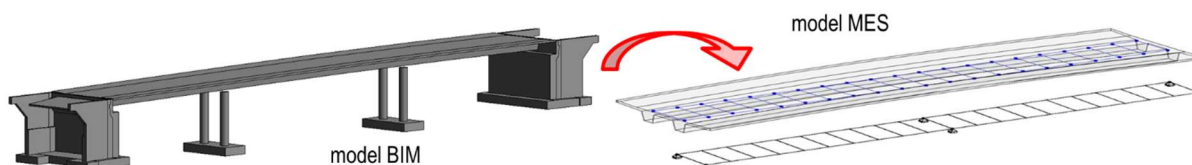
Przykład modelu bryłowego wiaduktu betonowego – widok z zewnątrz
